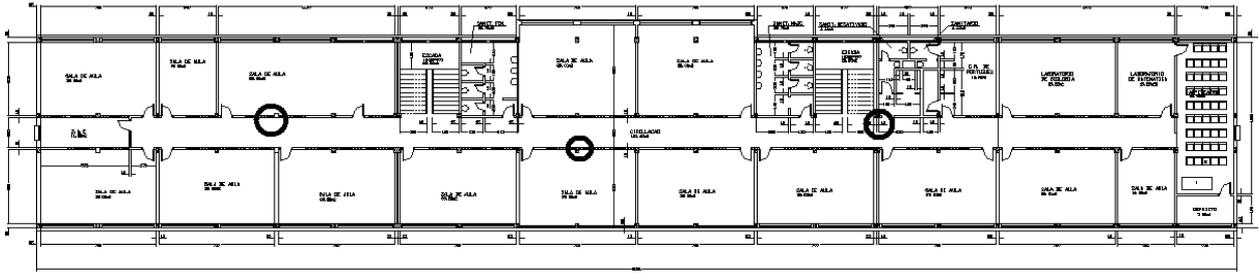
Localização recomendada para as tomadas de incêndio do terceiro pavimento.
